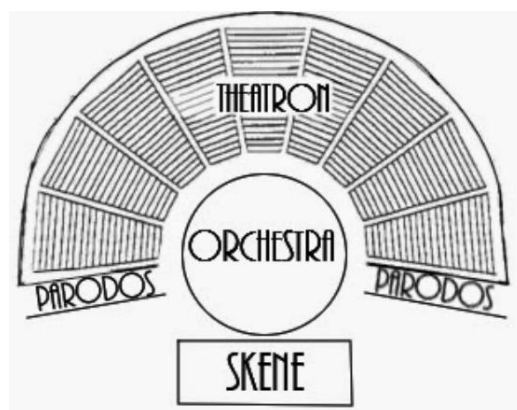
Planta Esquemática de um teatro grego. [27]
